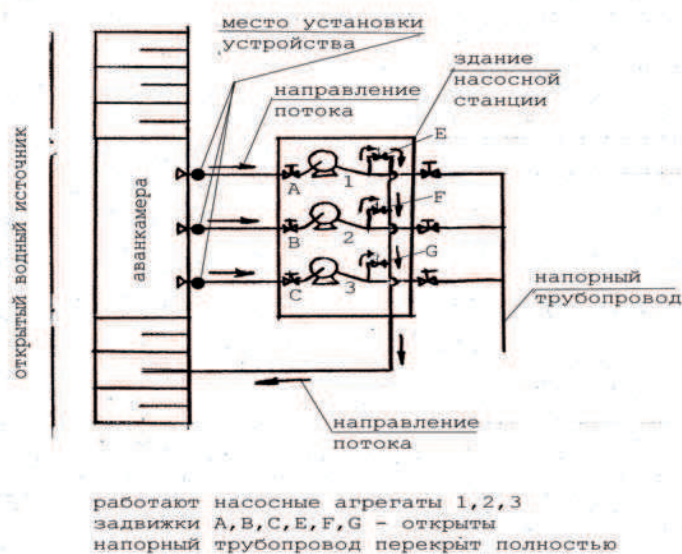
Схема работы насосной станции при прямой промывке всасывающих трубопроводов
